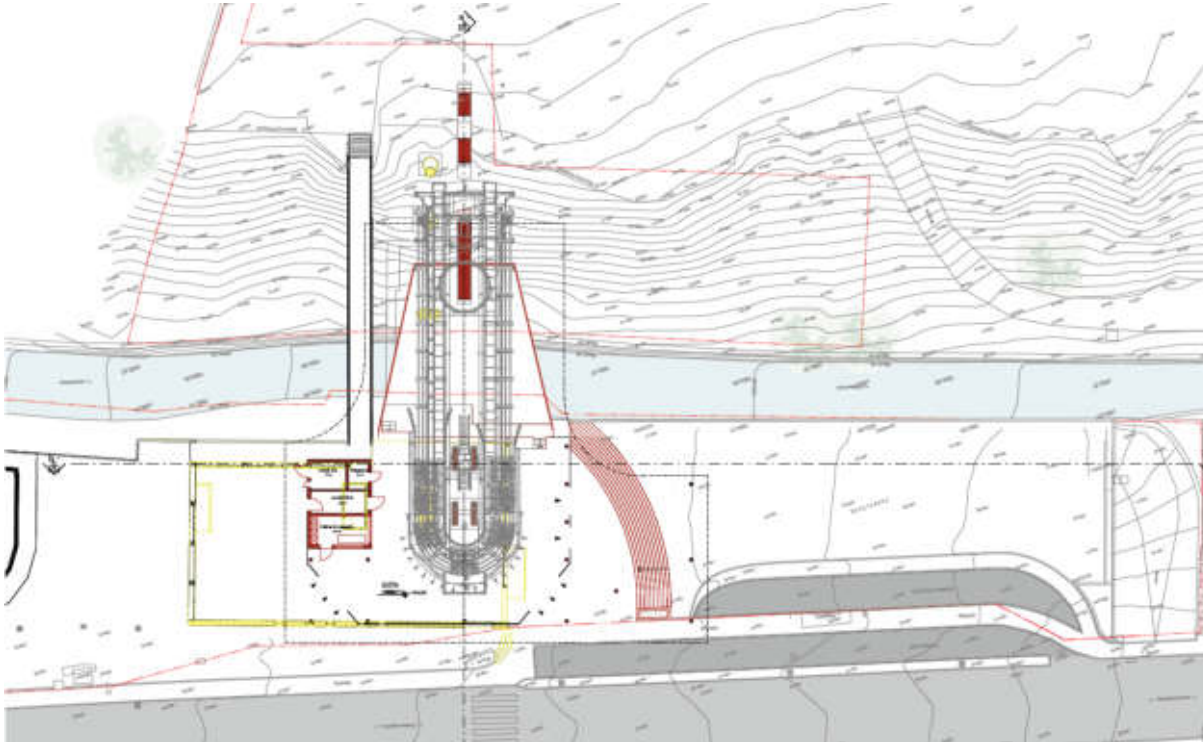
Projektauszug – Lageplan Einstiegsebene (Arch. Sader) / stralcio da progetto – pianta d'imbarco (Arch. Sader)
